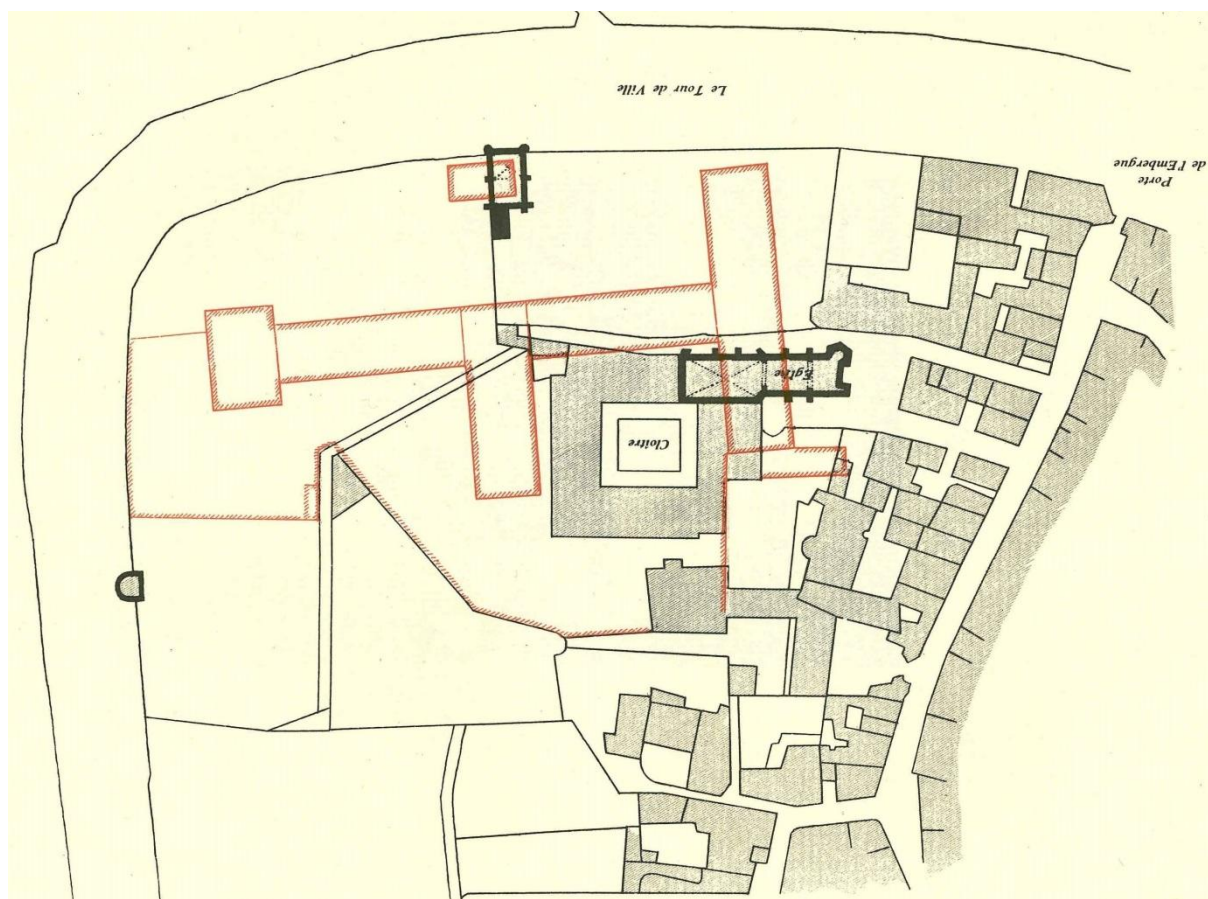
Vue du plan du rez-de-chaussée du projet de construction du Grand séminaire de Rodez. État du projet en date de 1828. Plan dressé par Treillet. AD12, 4 N 120.
